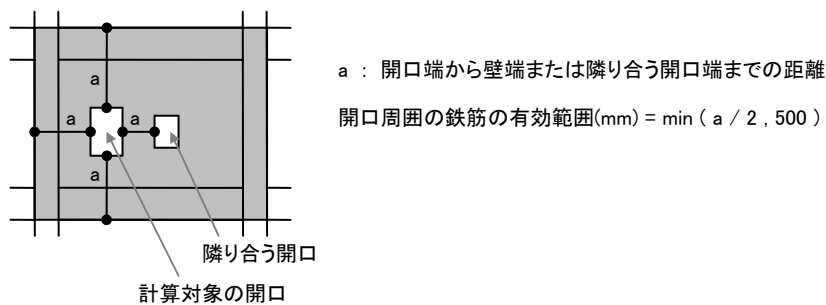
開口周囲の鉄筋の有効範囲
